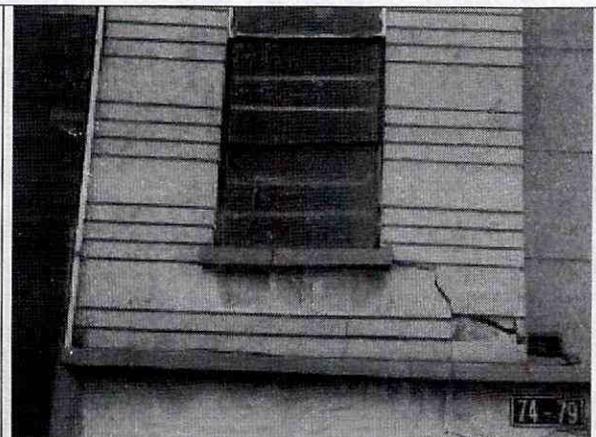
Agrietamiento en muro de fachada, costado sur
